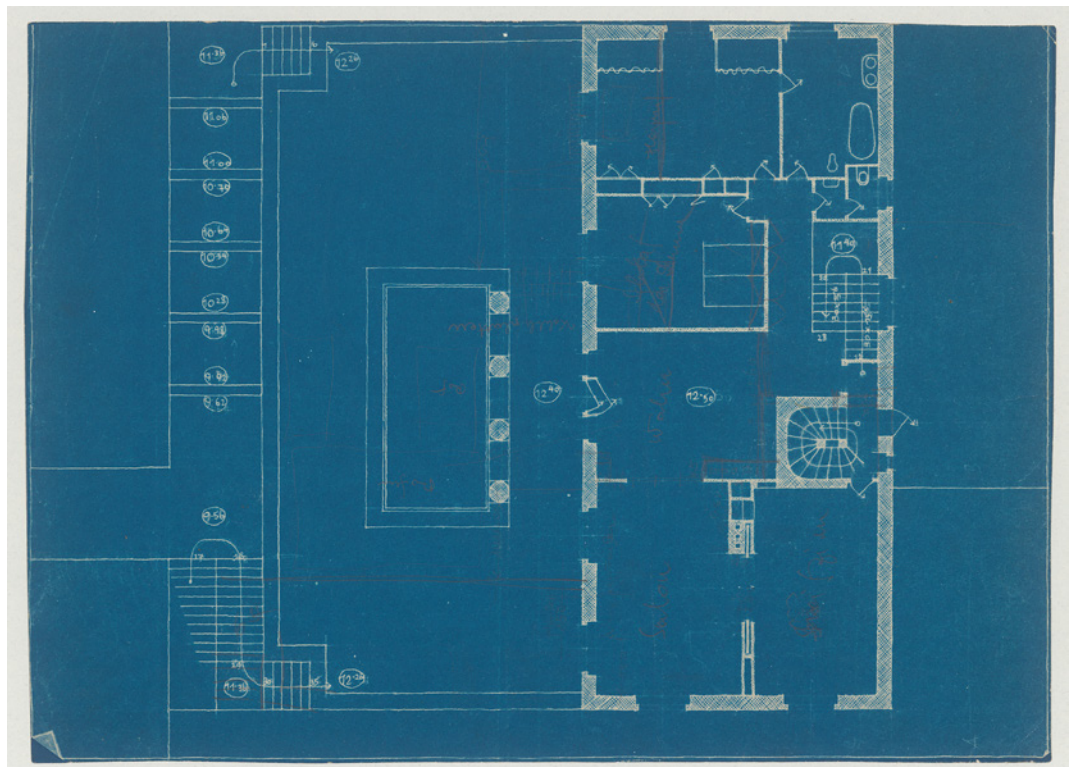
Oskar Strnad, Haus Hock, Wien, Grundriss des Erdgeschosses
